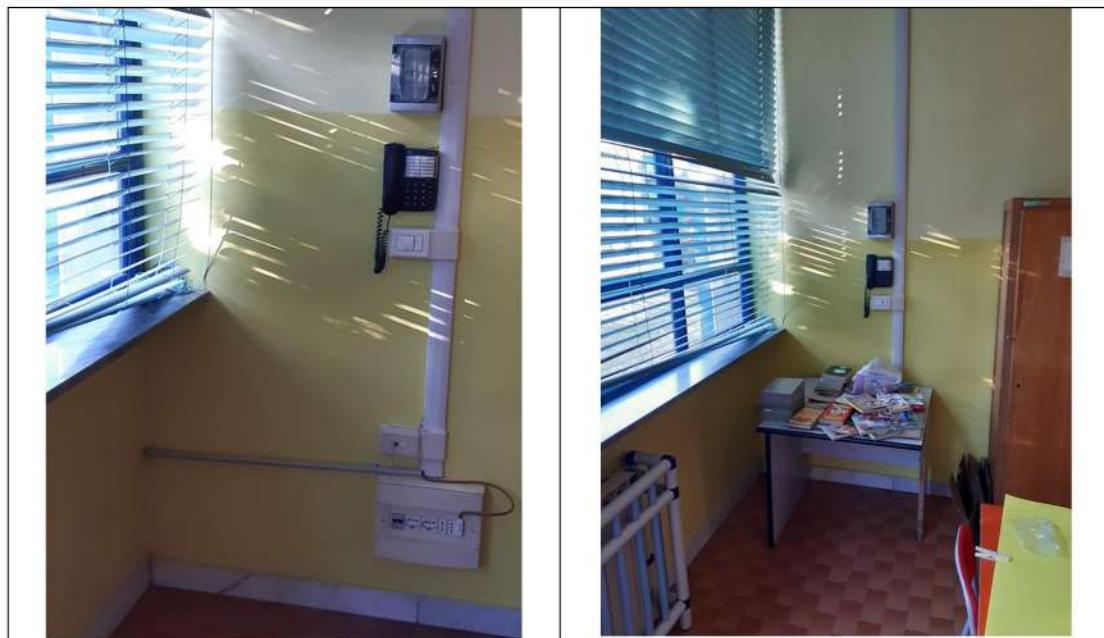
Plesso “Torrazza”: q. e. installato e tubo passacavo
